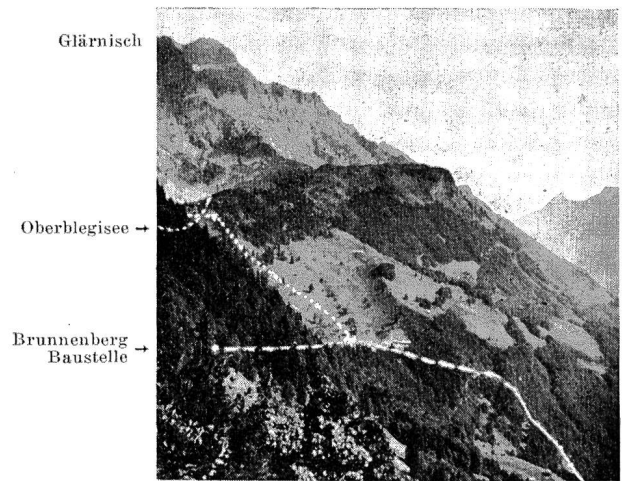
Kraftwerk Luchsingen II. Gesamtansicht der Gefällstufen Oberblegisee und Luchsingen II. ↘ Druckleitung zum Maschinenhaus Luchsingen.
